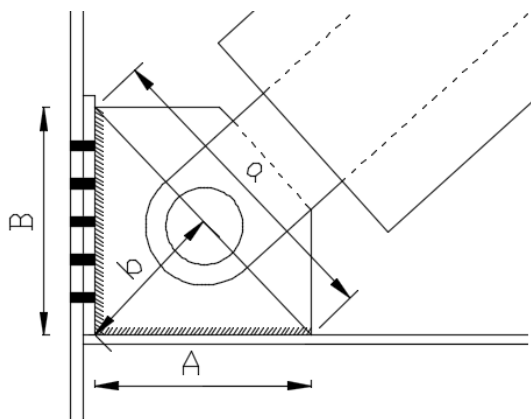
Dimensiones de gusset plate para la revisión por "gusset pinching".
